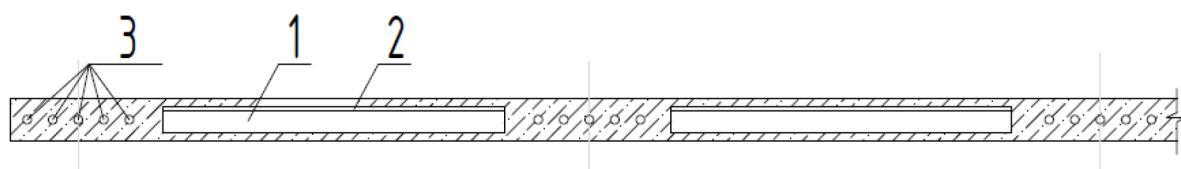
Схематичный разрез плитного фундамента рамной конструкции с постнапряжением:
